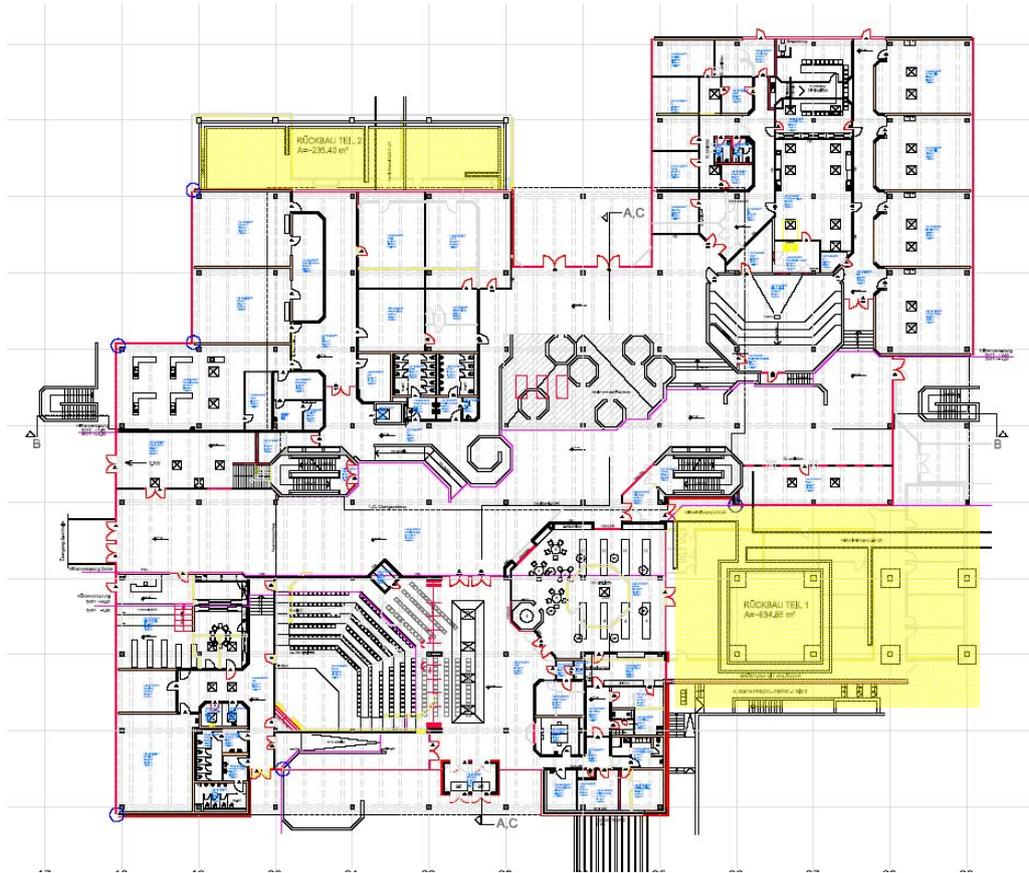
Grundriss Erdgeschoss mit Rückbaubereichen (gelb)
